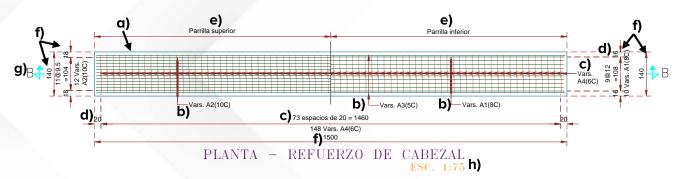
Ejemplo de planta del refuerzo de cabezal de pila
